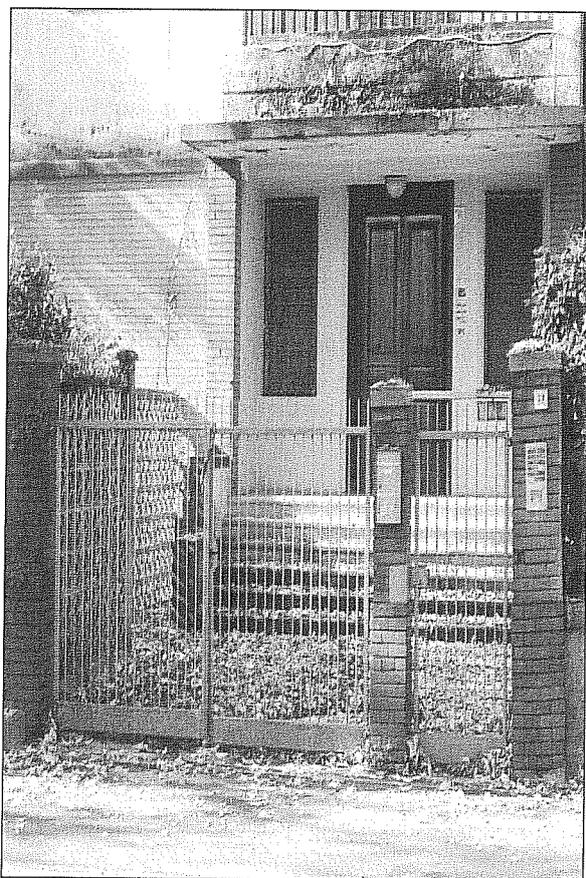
particolare fotografico dal quale si evince l'ingresso principale e secondario
